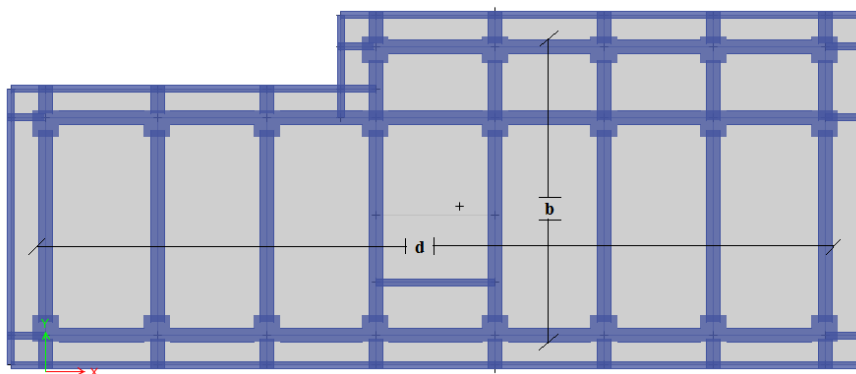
Dimensiones de la estructura en planta, sin contar voladizos. Losa del nivel por encima de la interface de aislación
